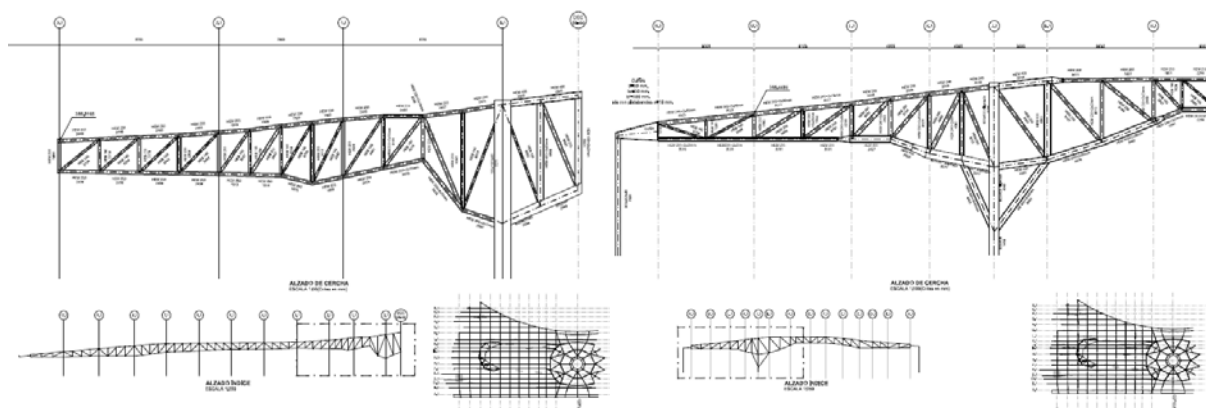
Geometría tipo de cerchas principales (N-S) y secundarias (E-O)
